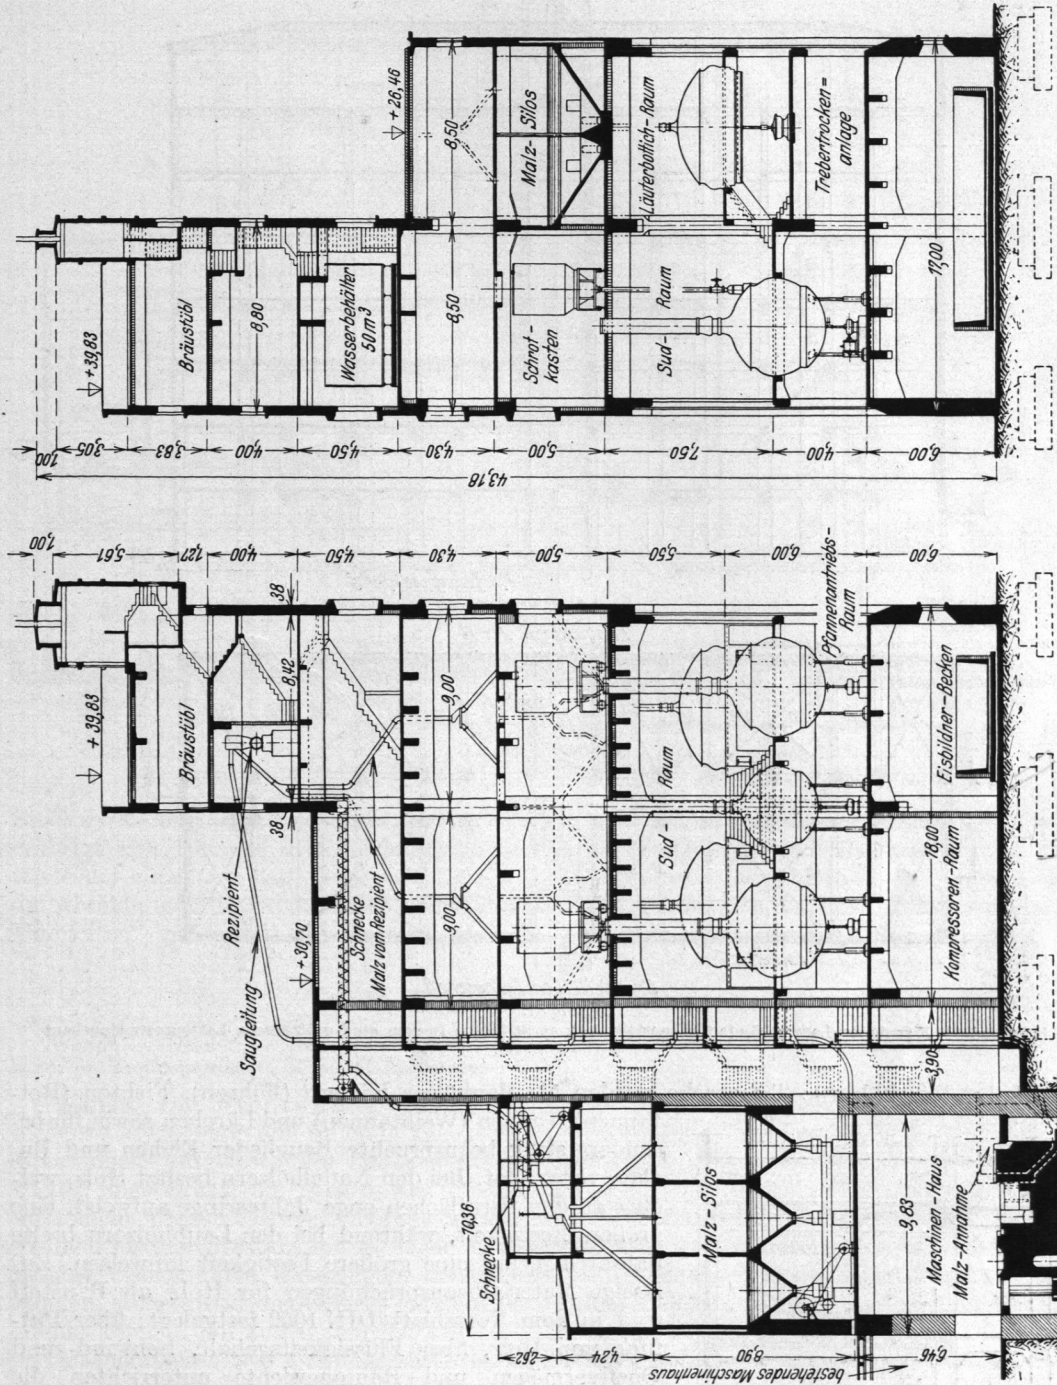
Sudhochhaus in Eisenbeton für eine Brauerei.
